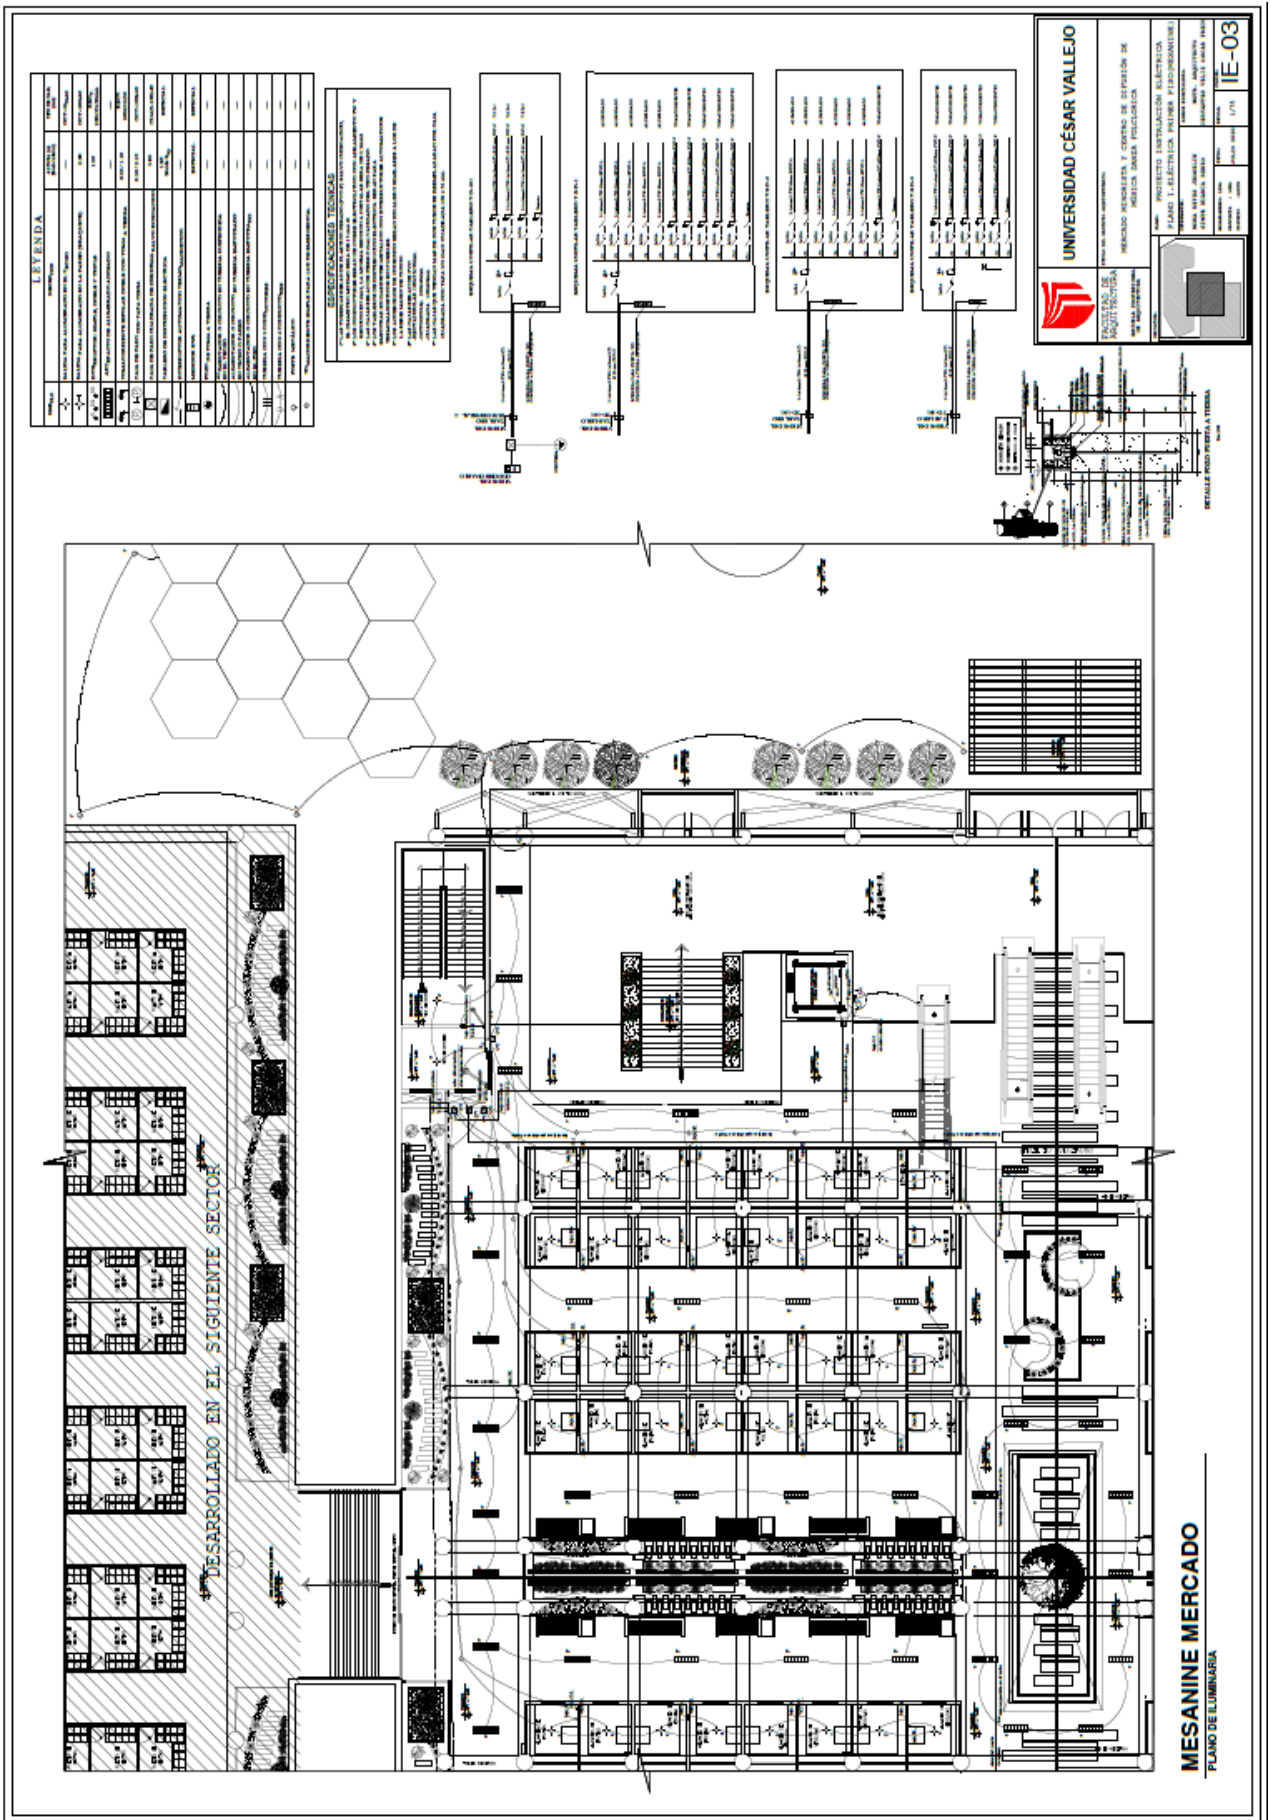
Plano Eléctrico, Mezanine Mercado - Proyecto
